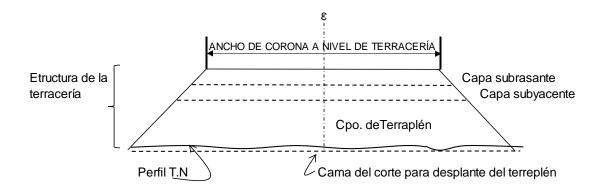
Estructura típica una sección de terracería en terraplén de una carretera...
